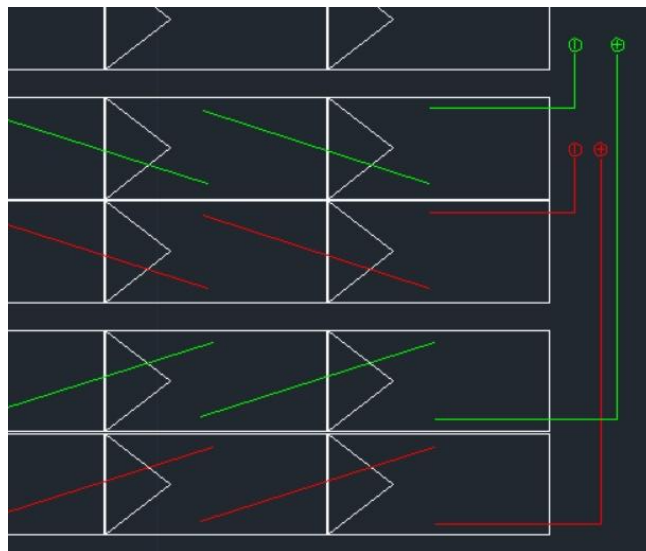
Strings* utilizando painéis de 02 filas separadas.
